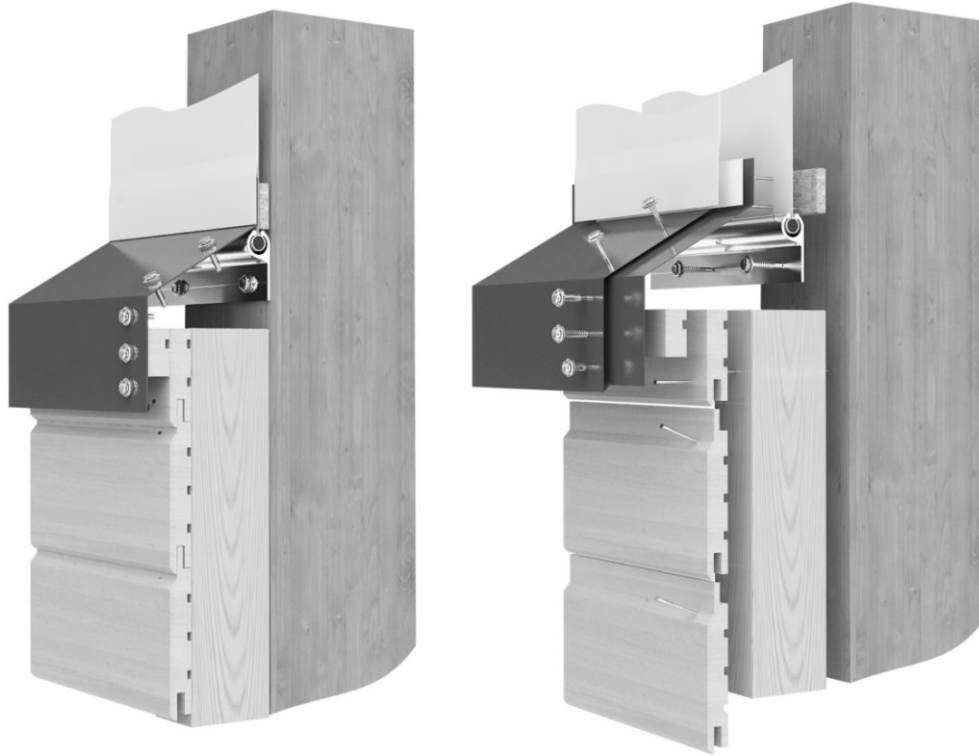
Fixation type 3 – coupe verticale sur traverse pignon rive haute
